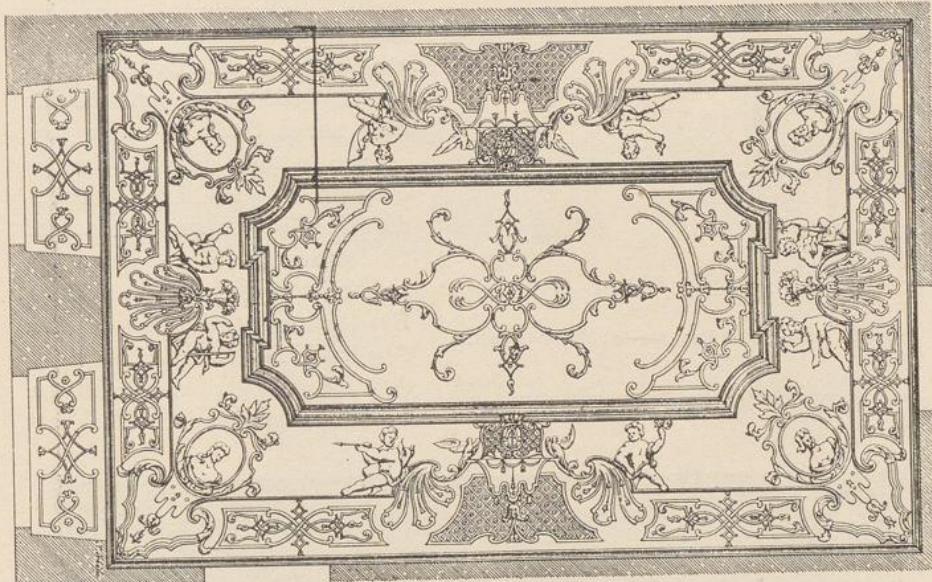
Lichtenstein; Decke im ersten Obergeschoss.
